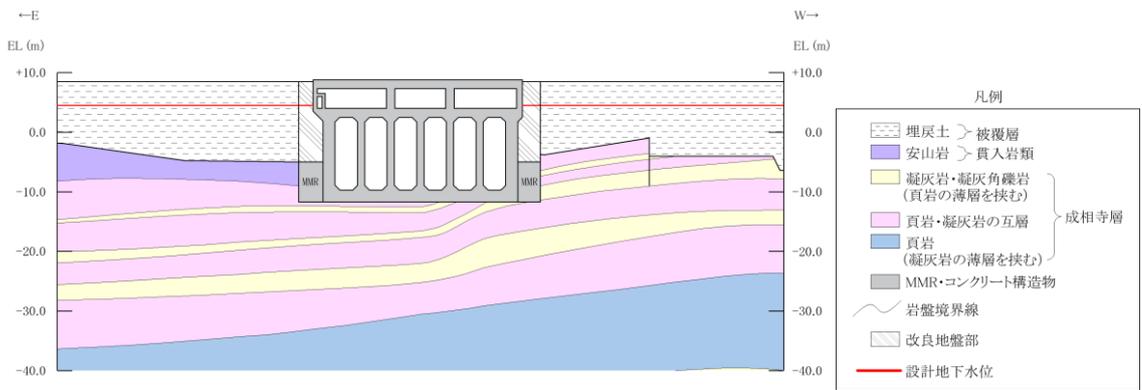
(1) 取水槽 地質断面図 (A-A 断面)
